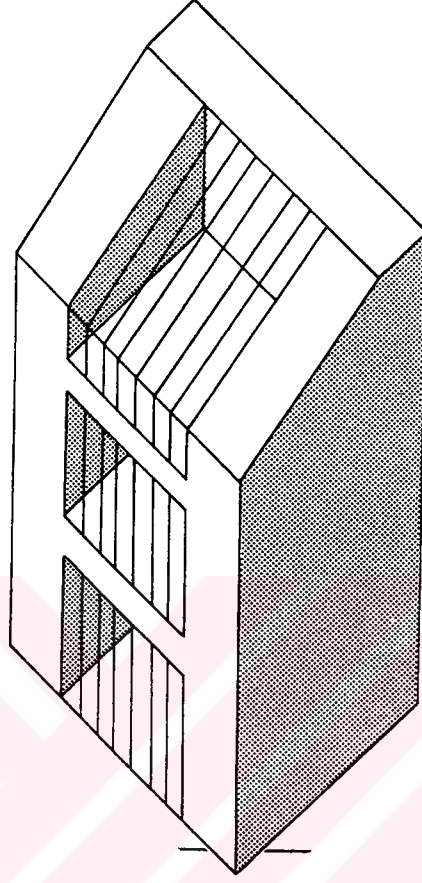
Hollanda Sosyal Yardım Bakanlığı, plan şeması
